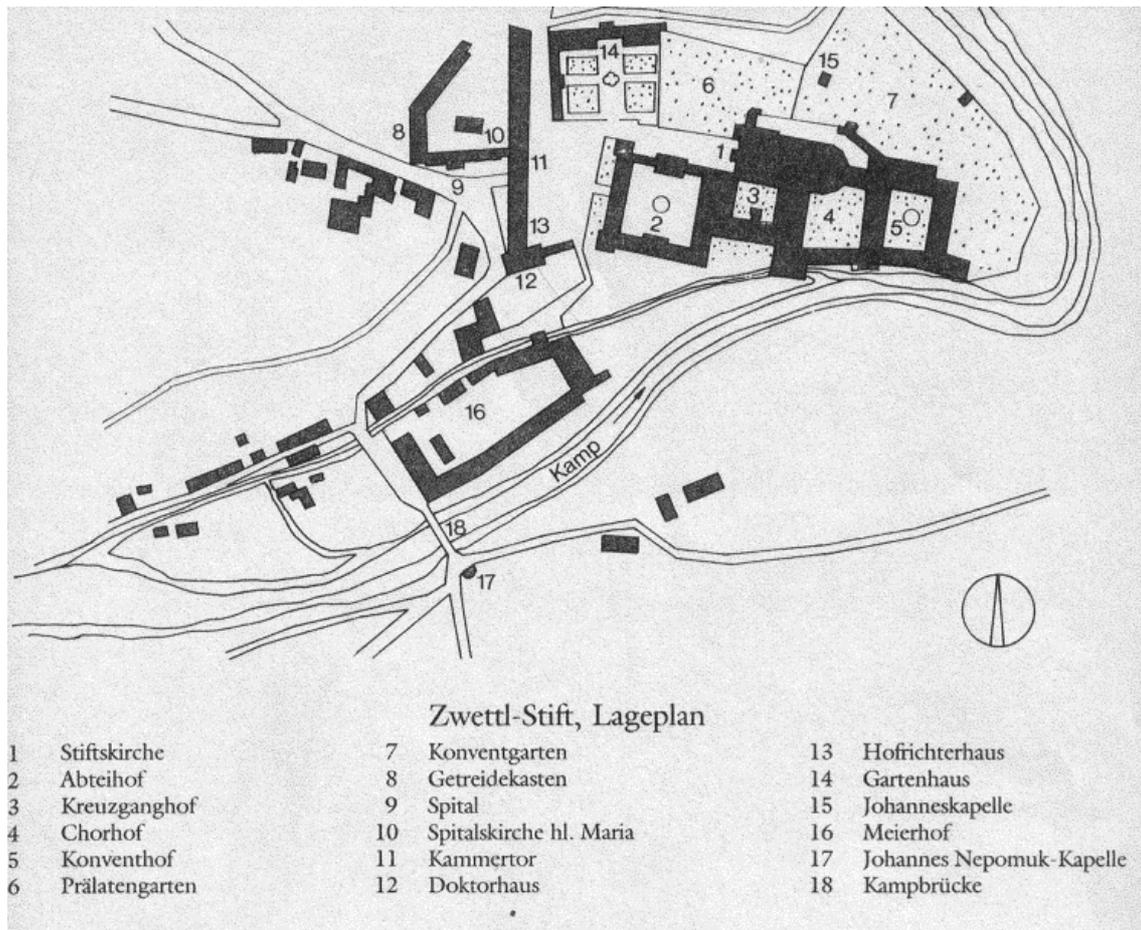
Zwettl, Zisterzienserstift Zwettl und Umgebung, Grundriss
